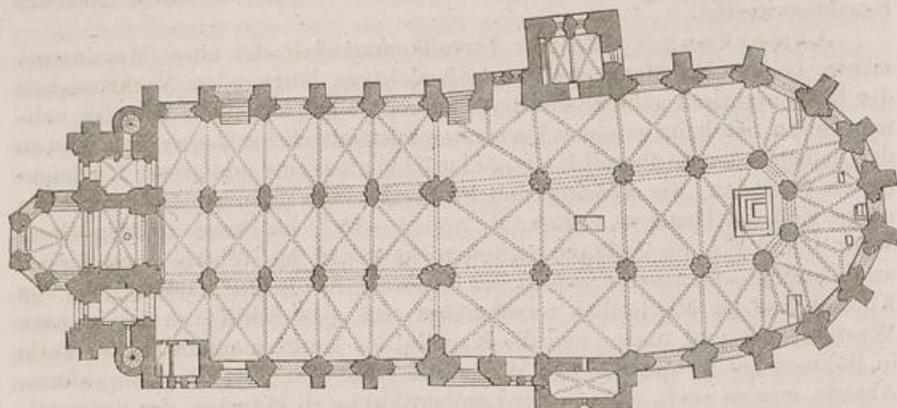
Grundriss der Sebaldskirche in Nürnberg (nach Heideloff).
